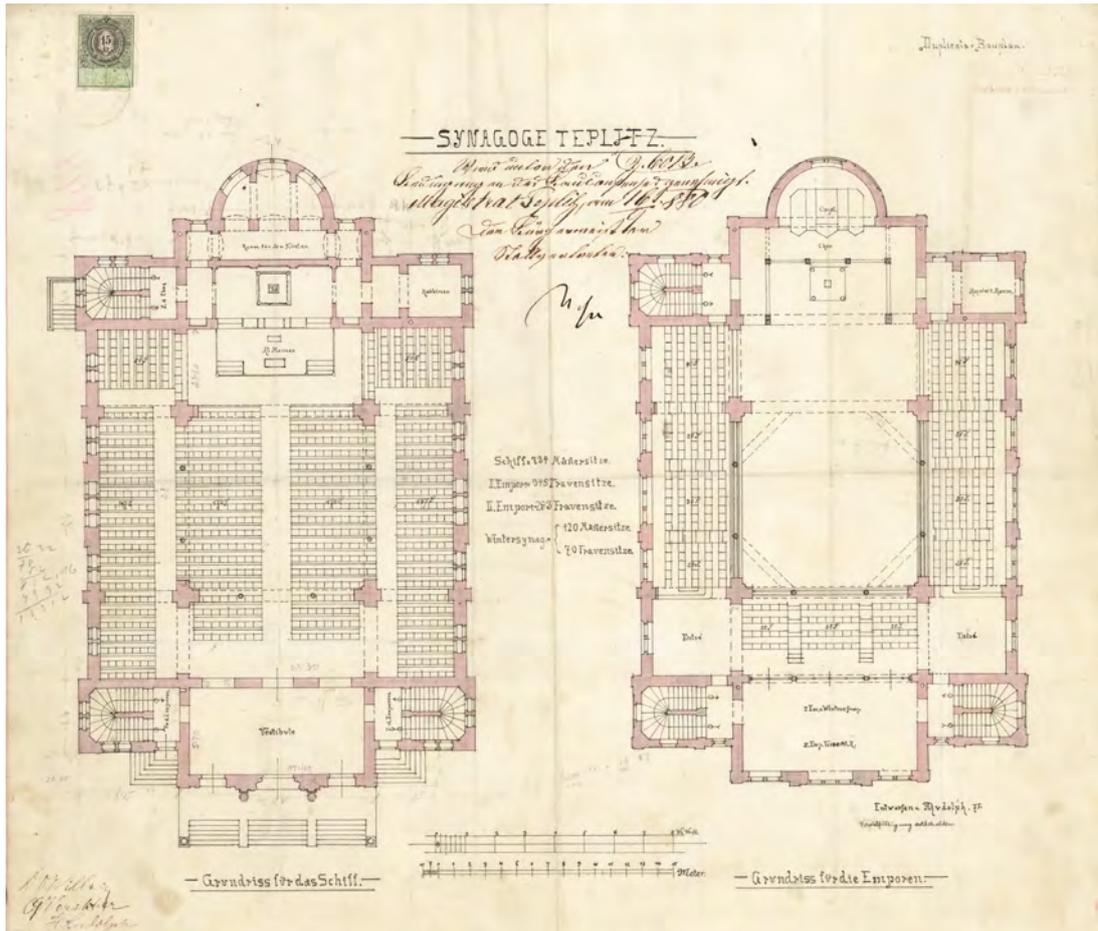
Grundrisse Einreichplanung, 1880
